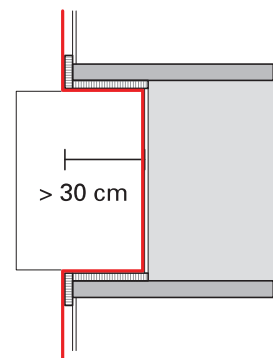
Messebene der thermischen Gebäudehülle bei Gebäudevorsprüngen und Balkonen (Grundrisse)
